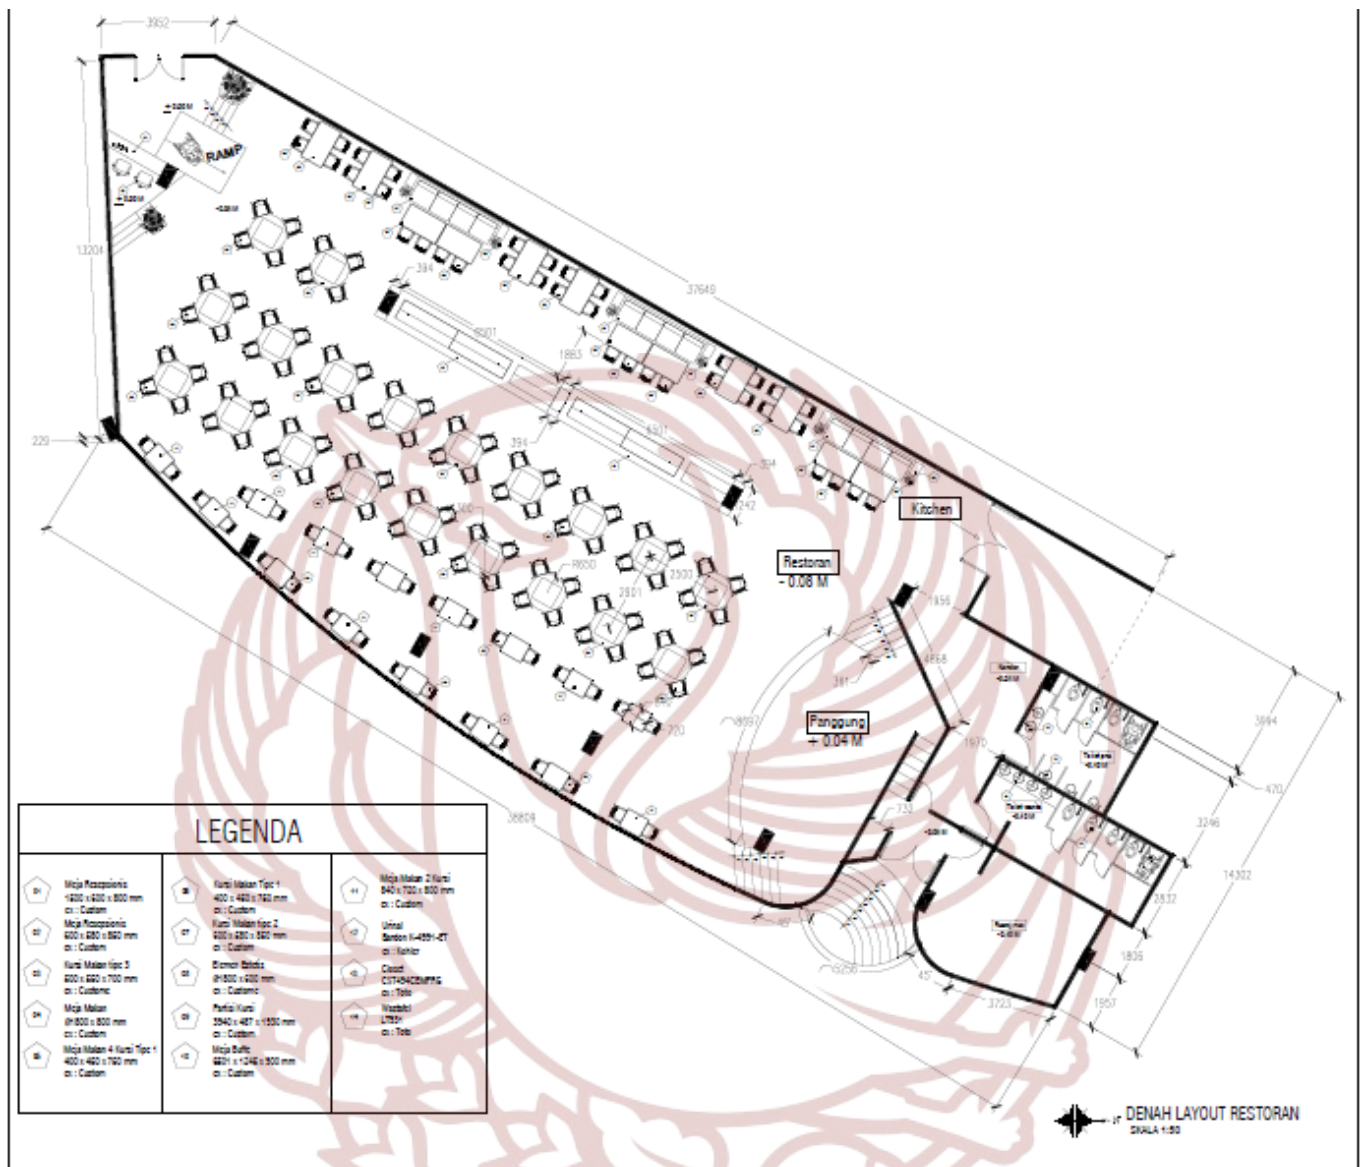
Layout Tata Letak Ruang Lantai 2
